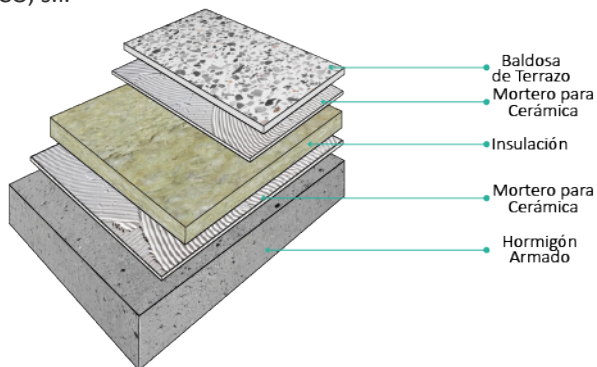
Detalle de Aislamiento Térmico en Losa de Entrepiso.
